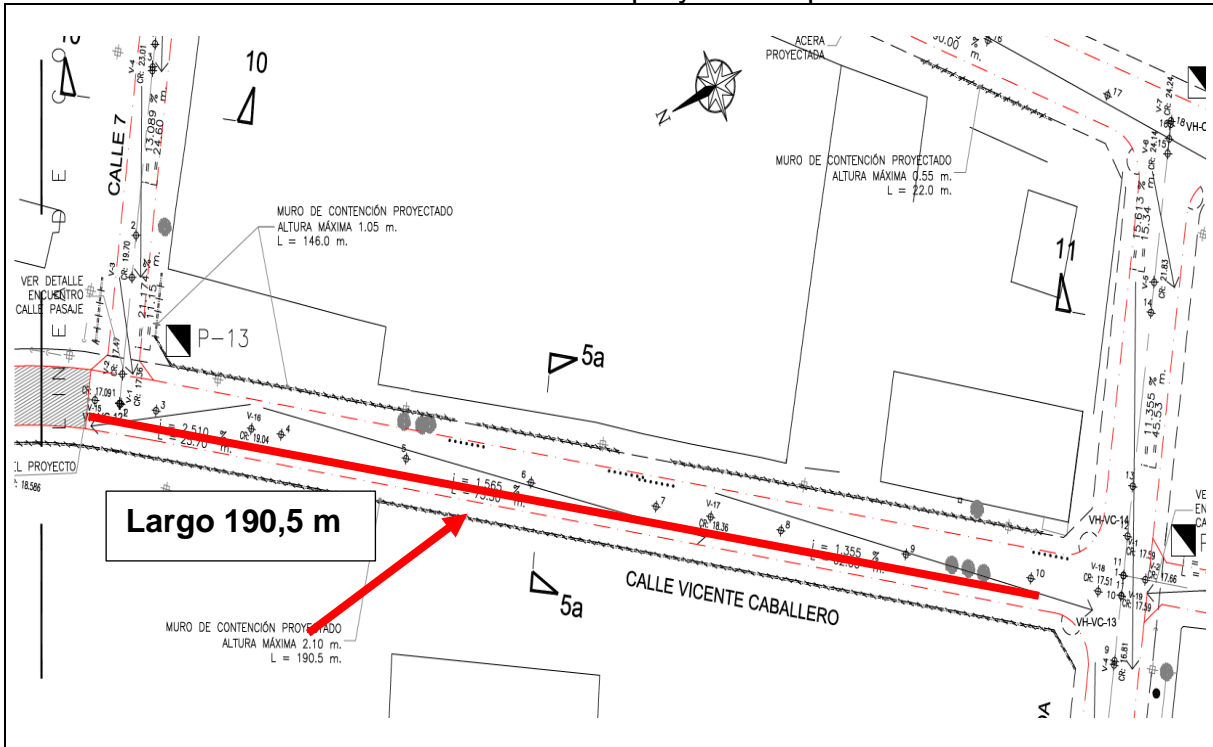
Detalle de muro hormigón armado G30,  $0,4m < h < 1,2m$ , de longitud de 190,5 m y de altura de 2,1 m proyectado según plano original de diseño geométrico, lámina 2 de 3.
